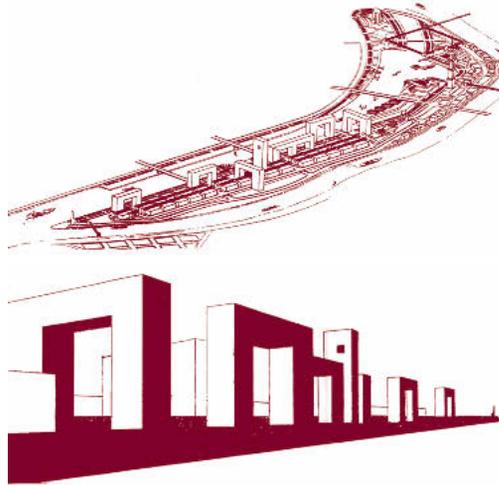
/ Bilbao. Planta y volumetría de la propuesta de ordenación
